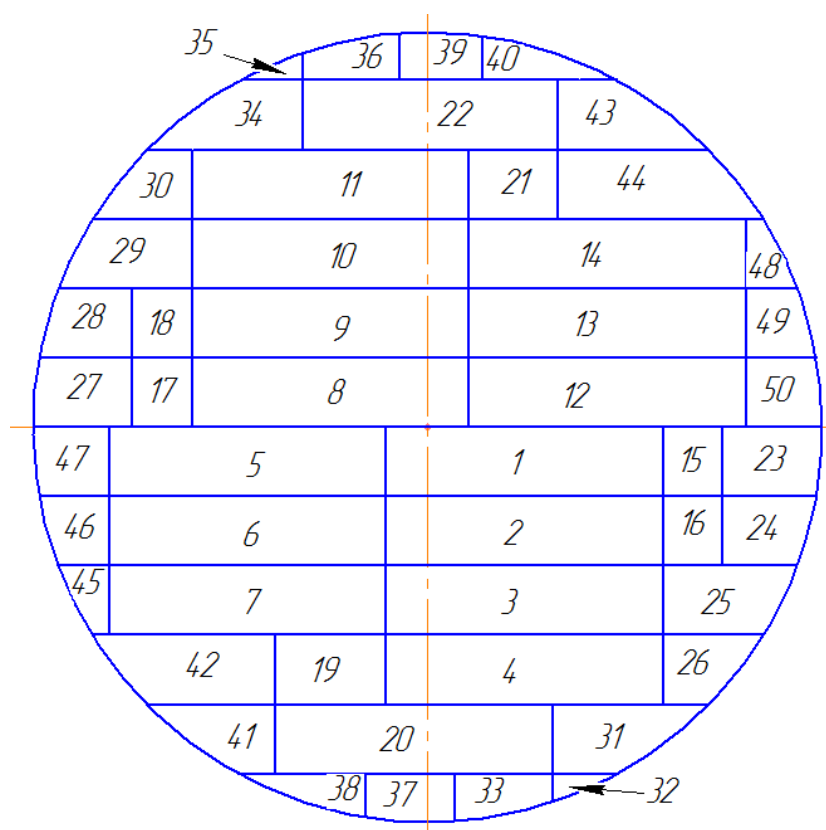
Последовательность сварки листов днища резервуара
